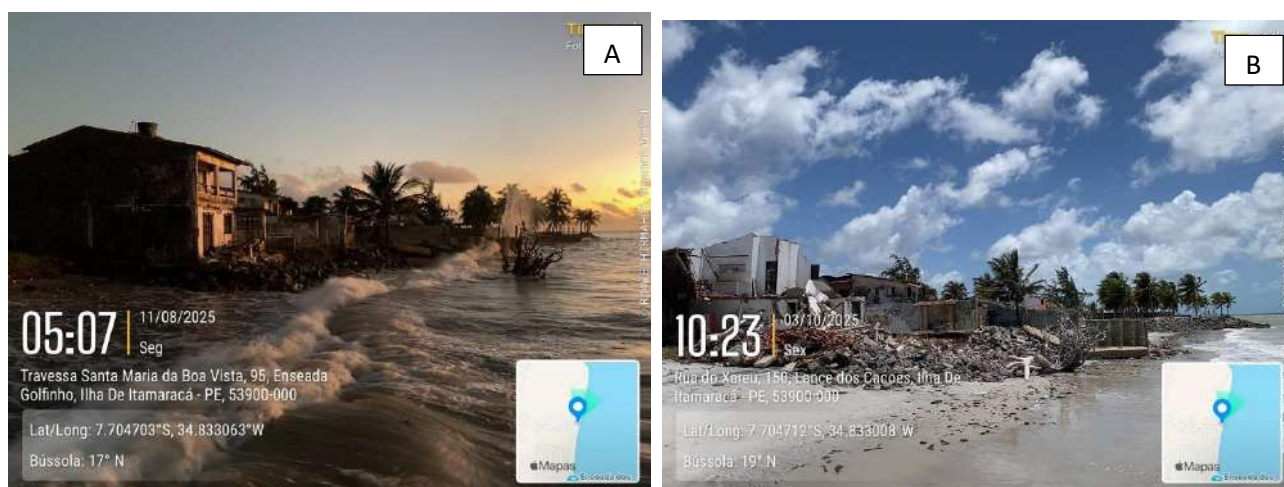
A: foto do imóvel em agosto de 2025; B: foto do mesmo imóvel em outubro de 2025, a estrutura colapsou.
